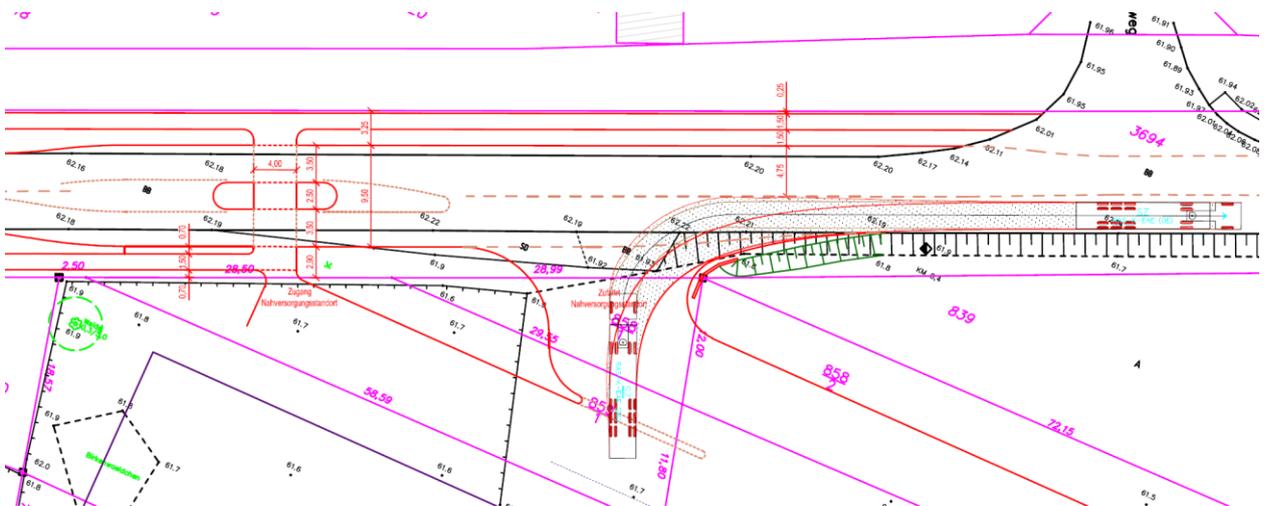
Lageplan Schleppkurve Ausfahrt 90° – Erschließung Nahversorgungsstandort, Quelle: Wunderlich GbR, 16.08.2022
